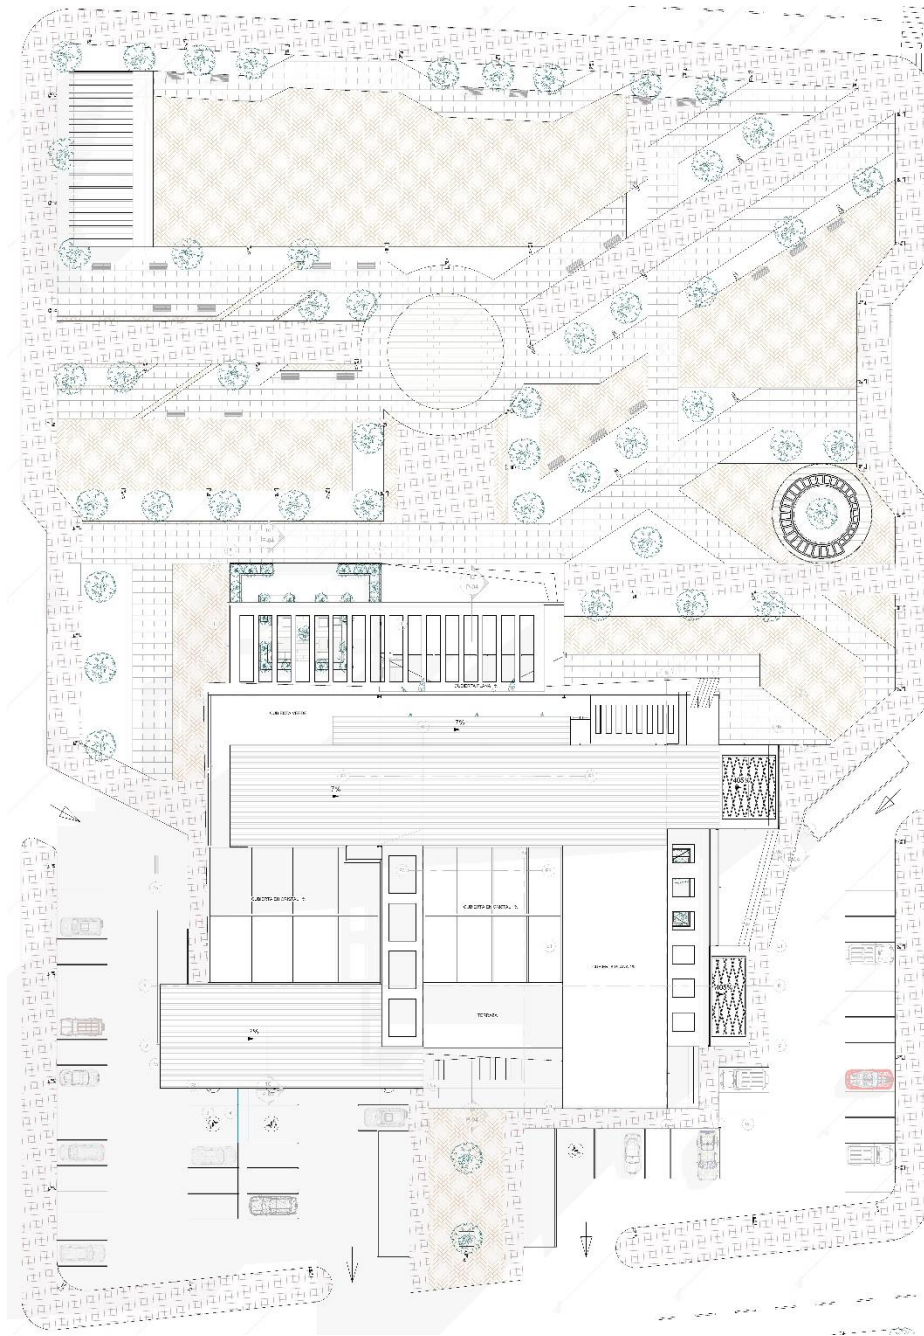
Planta de cubiertas: Tomado de: Autoría propia
